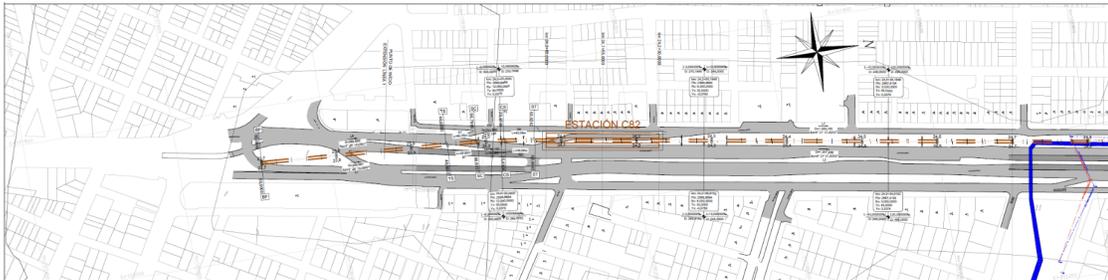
Vista en planta del trazado extensión de la PLMB, Tramo calle 72-calle 90
